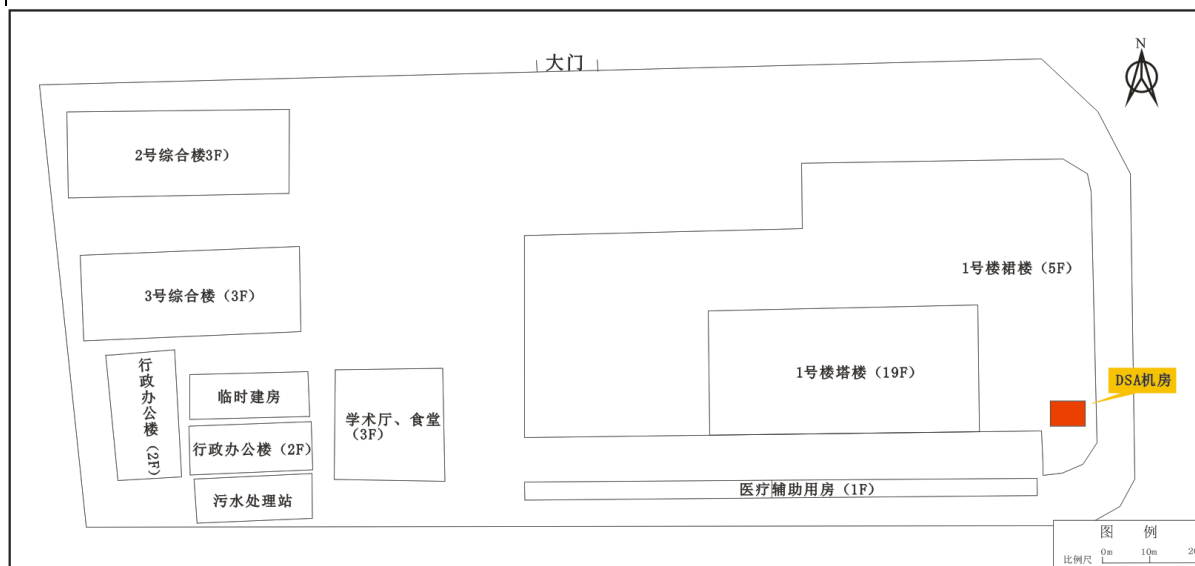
汉中铁路中心医院总平面布置及 DSA 机房相对位置关系示意图
